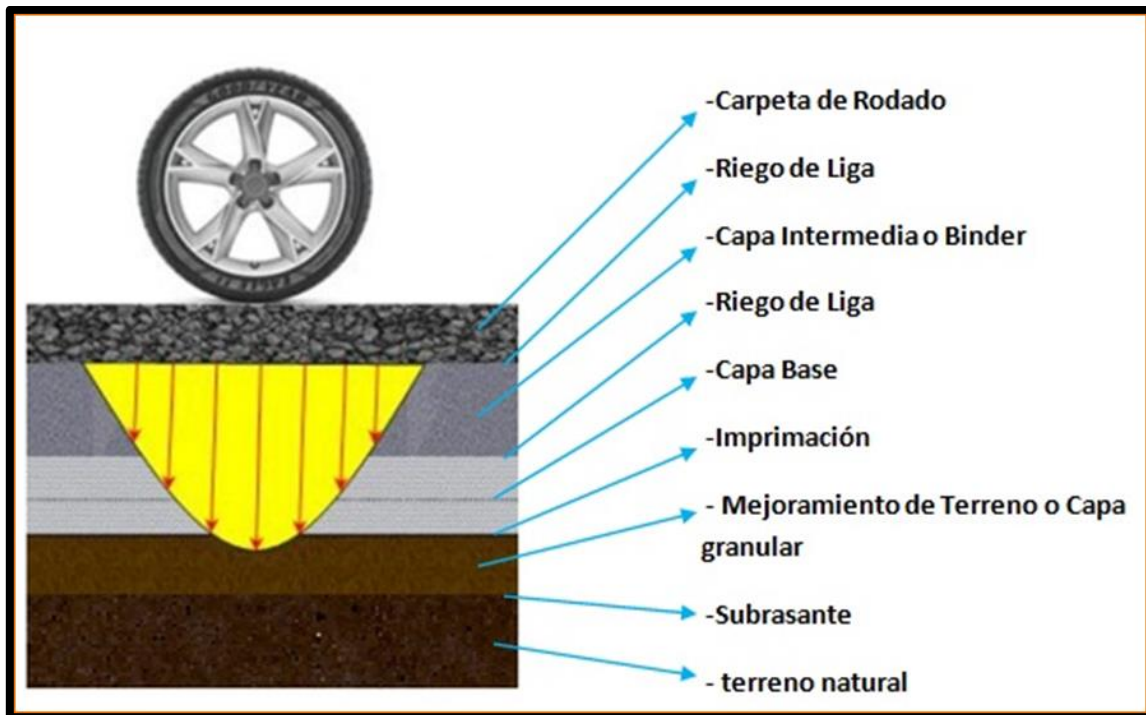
Estructura y distribución de esfuerzos en Pavimento Asfáltico. Fuente [1].
